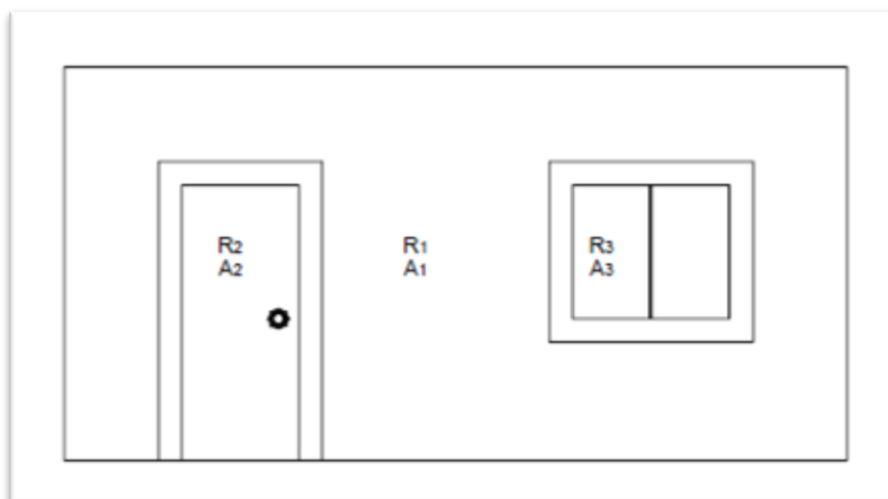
Ilustração esquemática de uma fachada de um edifício (Fonte: [10])
